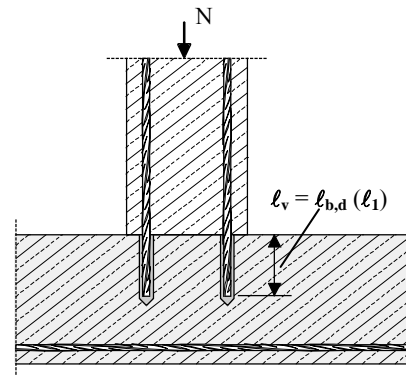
Ancrage direct d'armatures pour élément principalement en compression. Les armatures subissent une contrainte en compression.
